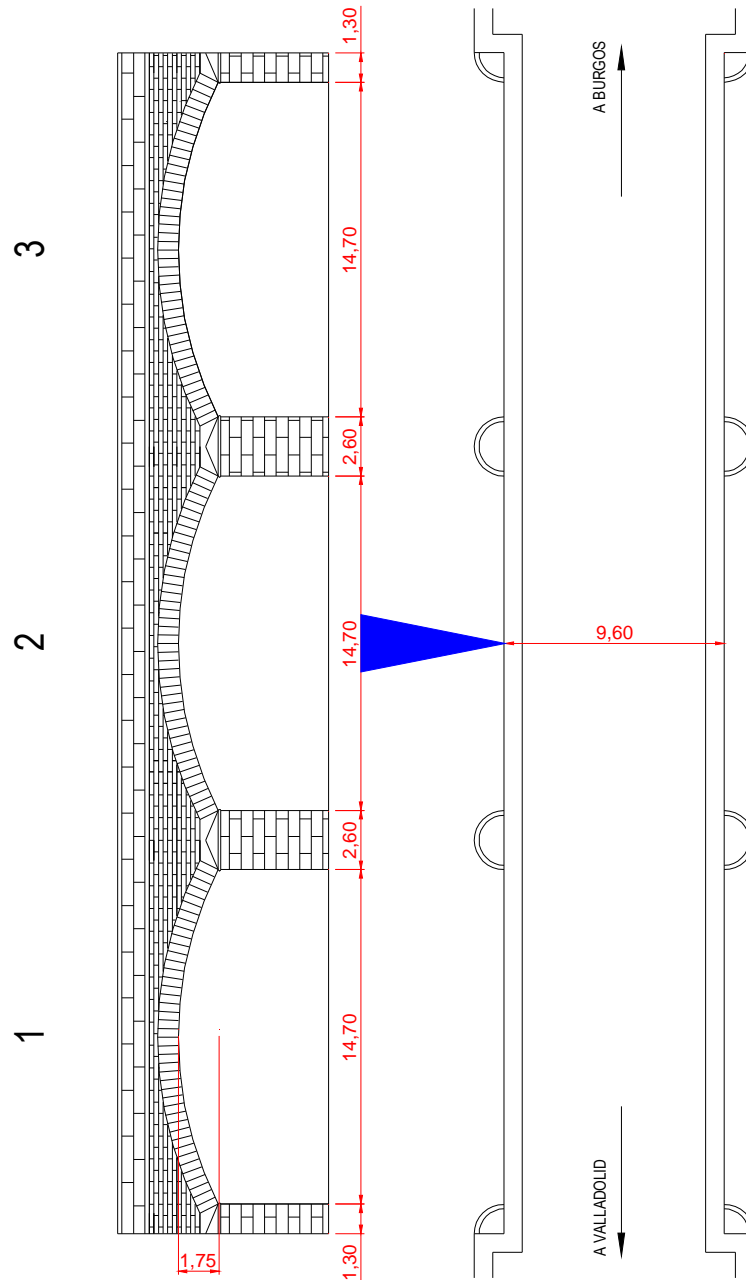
Dibujo de planta y alzado del puente de San Isidro en Dueñas.
